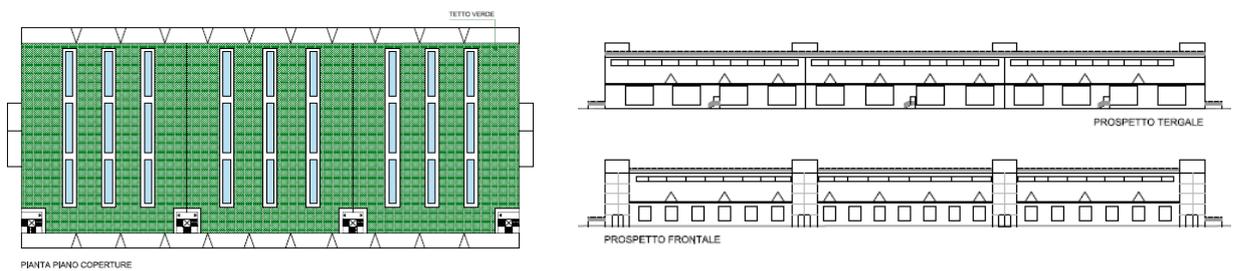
Pianta piano coperture e prospetto (tergale e frontale). Magazzino 14N
